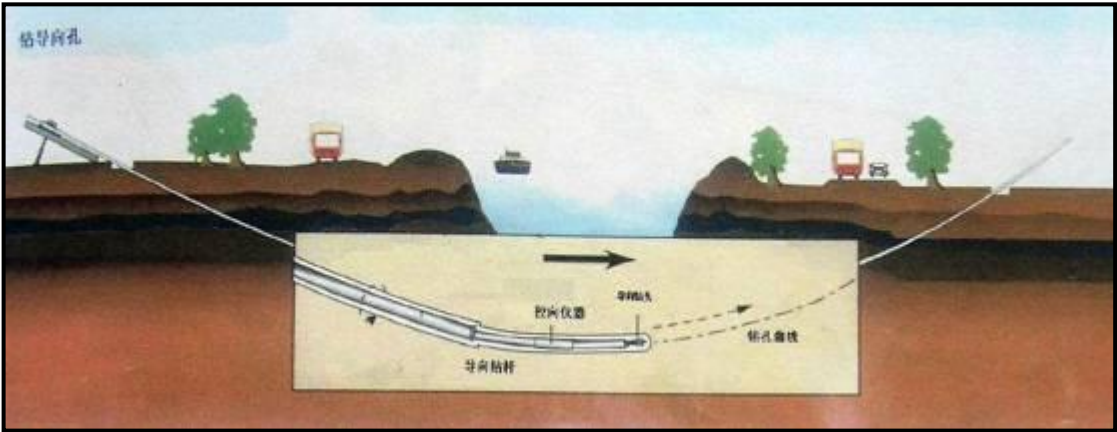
定向钻穿越施工钻导向孔过程断面示意图
